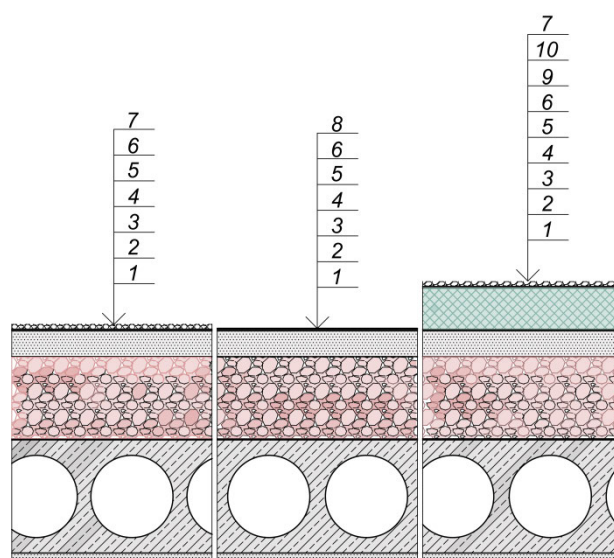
Схема ограждающей конструкции: 1 – штукатурка; 2 – железобетонная плита; 3 – пароизоляция; 4 – теплоизоляция; 5 – стяжка; 6 – гидроизоляция; 7 – защитный слой; 8 – композиционное покрытие «керамические микросферы – связующее»; 9 – теплоизоляция (дополнительный слой); 10 – гидроизоляция (дополнительный слой)
